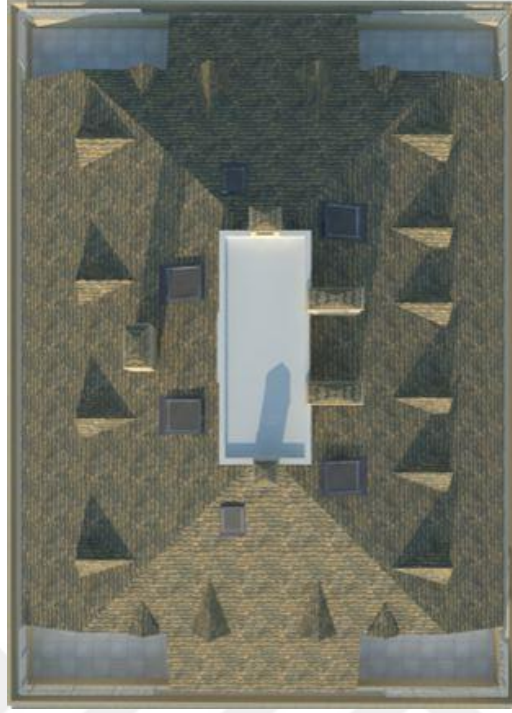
Binanın bulunduğu parseli gösteren vaziyet planı
